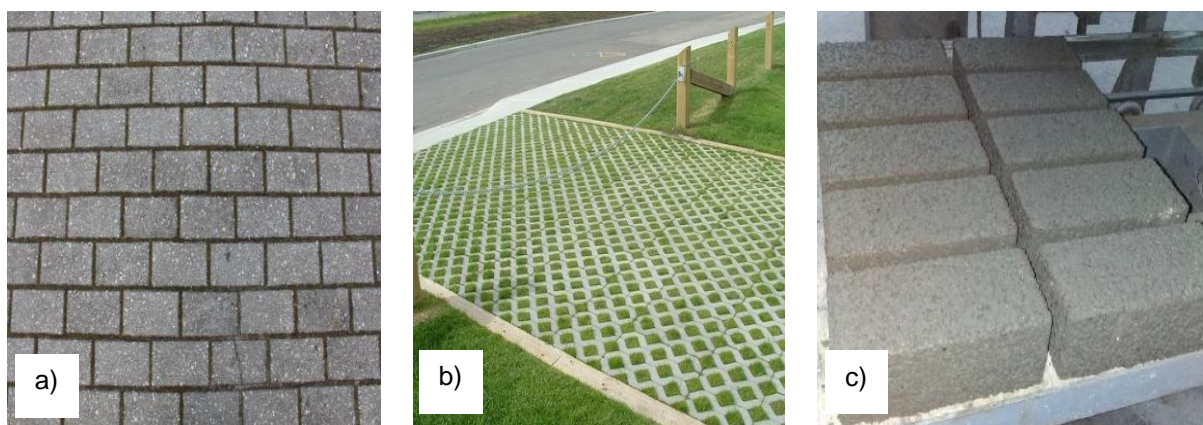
Pavimentos Intertravados permeáveis – a) juntas alargadas; b) áreas vazadas e; c) peças de concreto permeável.
